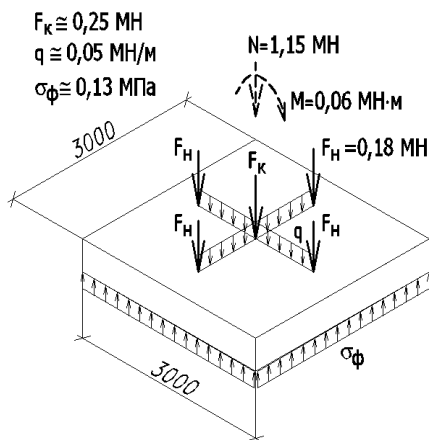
Расчетная схема системы «колонна с консолями – фундамент» на расчетные эксплуатационные нагрузки
